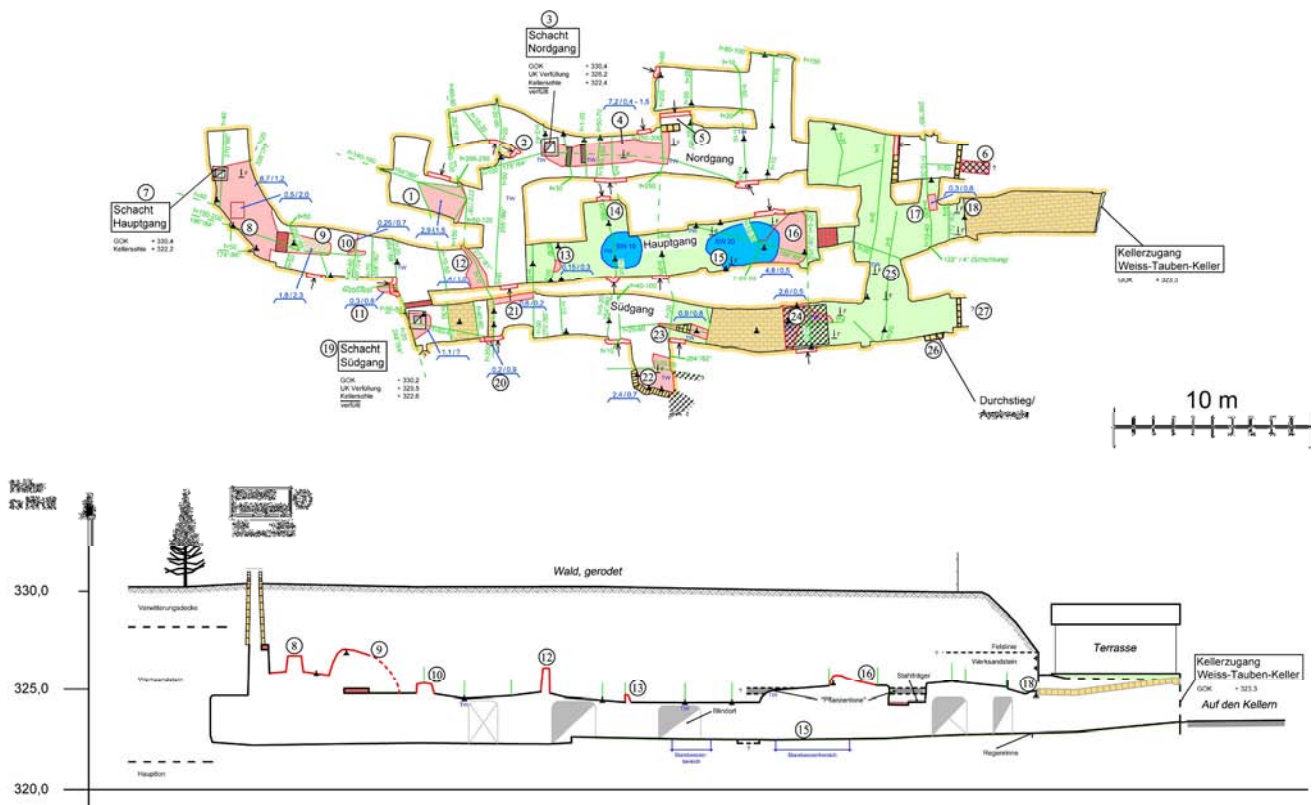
Grundriss der Kellergänge und Schnitt durch den Hauptgang
